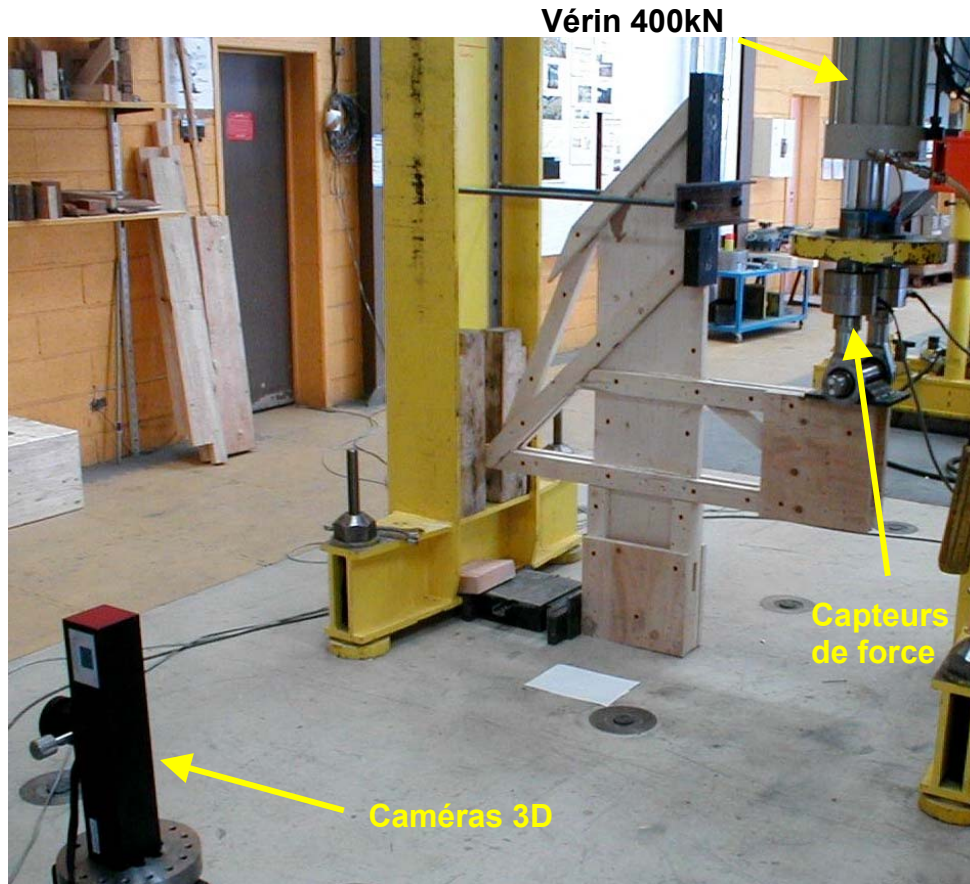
Dispositif expérimental pour les essais d'assemblage d'angle de portique.
